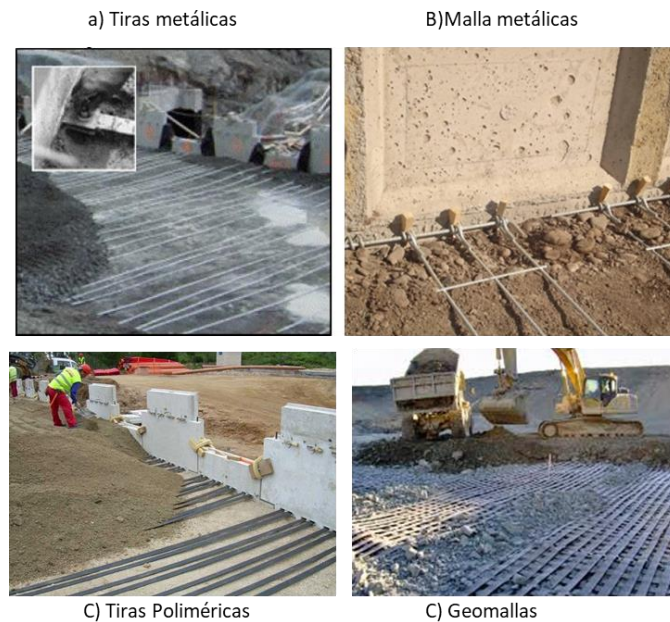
Tipos de Refuerzos. A) Tiras metálicas, B) Malla metálica C) Tiras Poliméricas, D) Geomalla.
